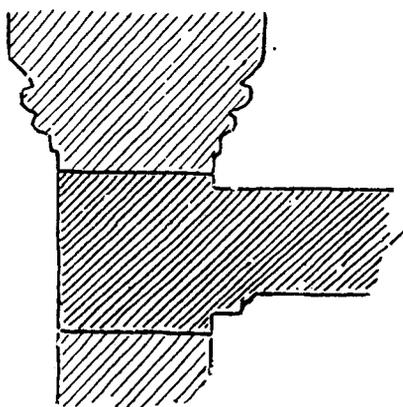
ASSEMBLAGE DES ÉTRÉSILLONS D'ANKOR VAT.
